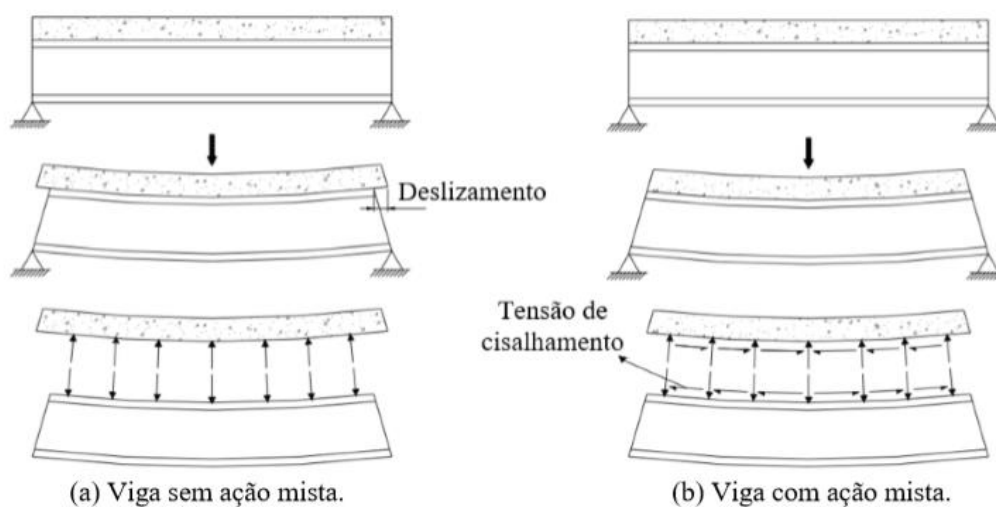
Viga Híbrida e viga mista sujeitas a flexão.
